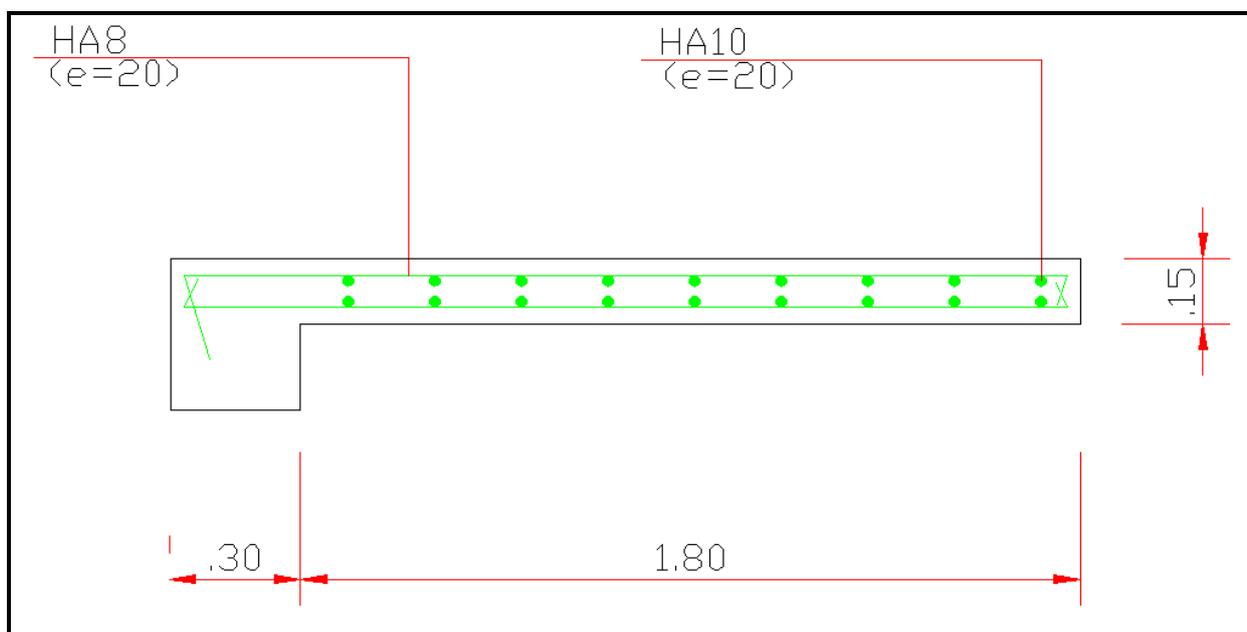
ferrailage balcon 02 (coupe B-B).
